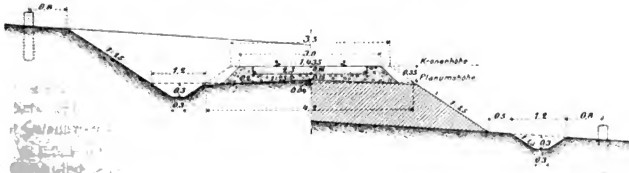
Querschnitt einer Nebenbahn. M. 1:100.
